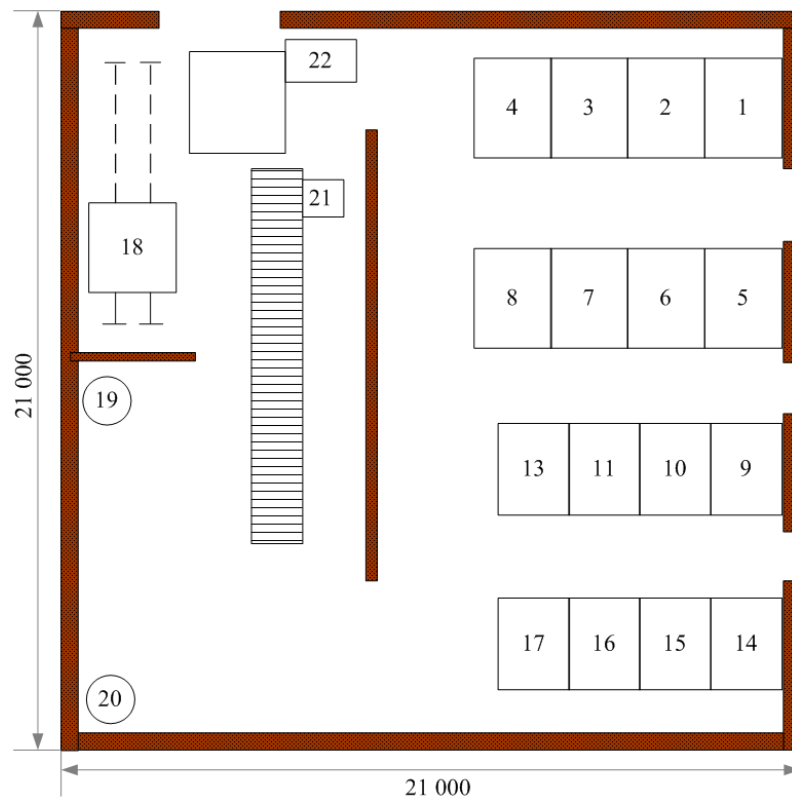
План відвантажувального відділу (№6 на генплані)
